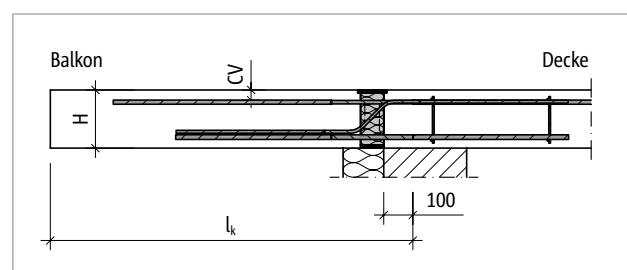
Schöck Isokorb® T Typ KP-M13 bis M14: Statisches System
